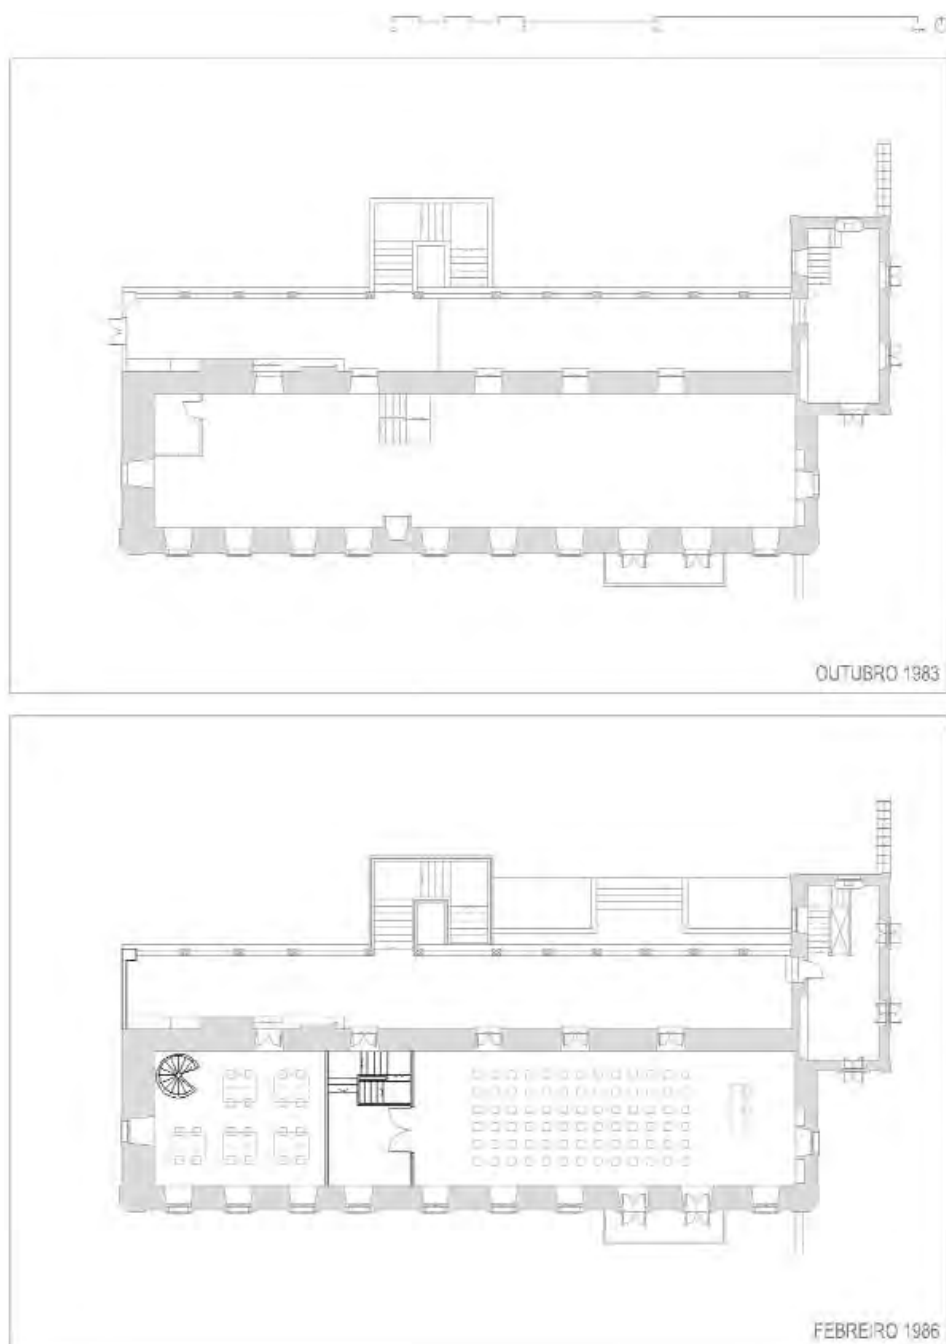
SANTO AGOSTIÑO. Planta primeira.
